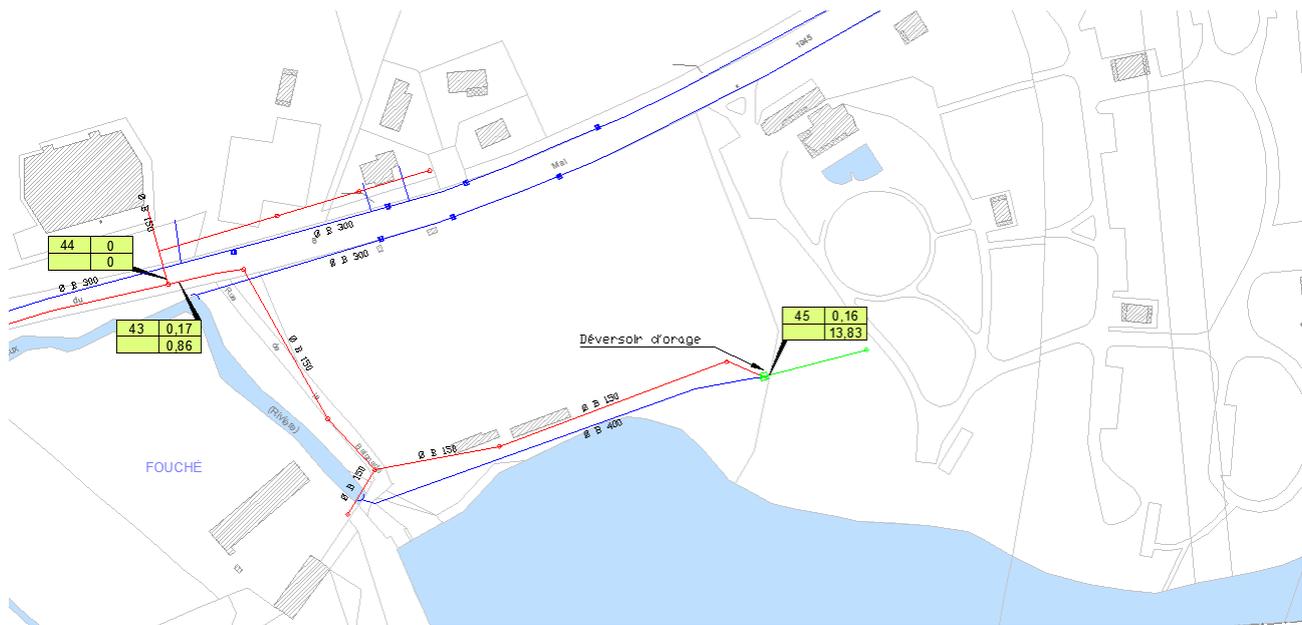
Plan des réseaux de collecte sur la zone d'étude
